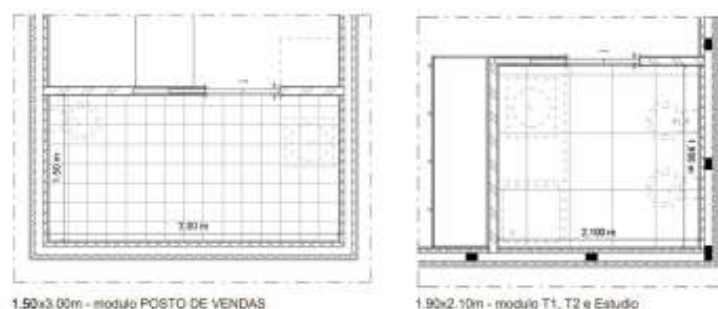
As duas tipologias tipo de instalações sanitárias.
